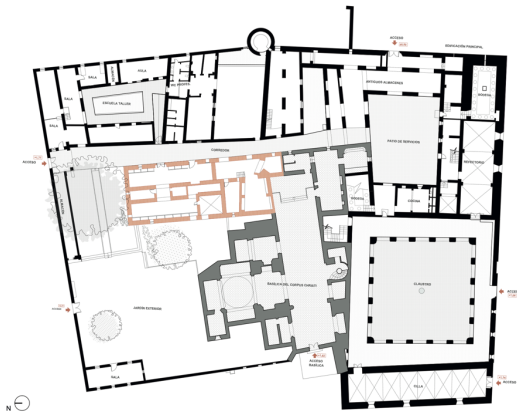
Planta monasterio Corpus Christi de Llutxent donde se destaca el Pabellón de los Legos dentro del conjunto. Fuente: Propiedad de la autora
